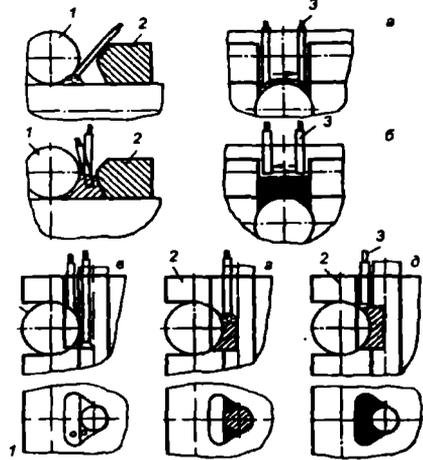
Дуговая сварка крестообразных соединений стержней с принудительным формованием шва:
